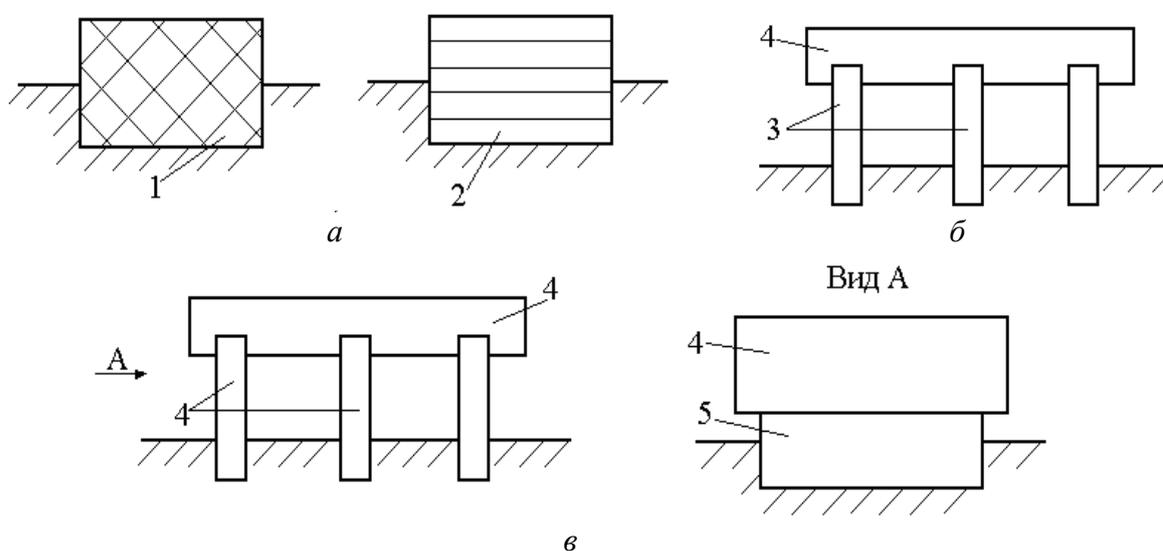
Виды фундаментов: *а* – массивные; *б* – рамные; *в* – стенчатые; 1 – монолит; 2 – плиты; 3 – стойки; 4 – опорная плита; 5 – стенки
